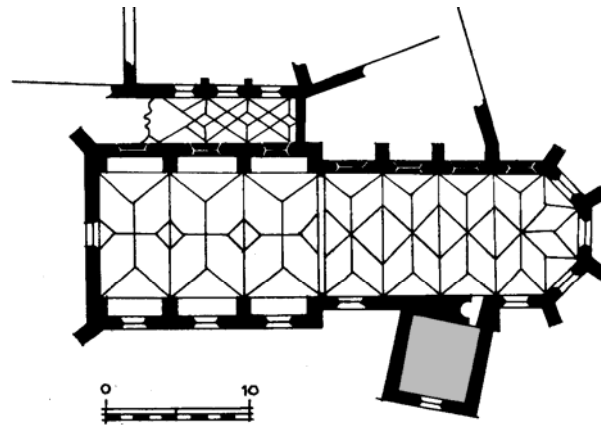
Grundriss Wallfahrts- und Klosterkirche St. Maria in Klausen mit Sakristei/Bibliotheksbau und Reste des nördlichen Kreuzgangflügels, der heutigen Theresienkapelle (nach WEBER [2003a], S. 204).
